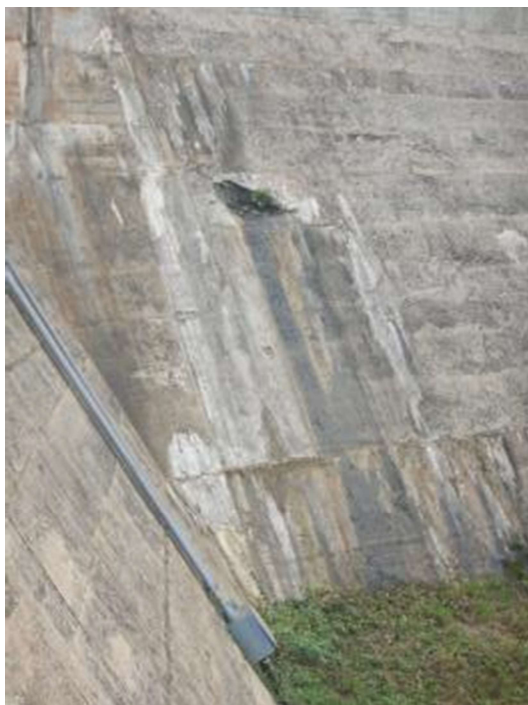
Filtraciones lado izquierdo con un deterioro muy local del hormigón (posiblemente falla de construcción)
